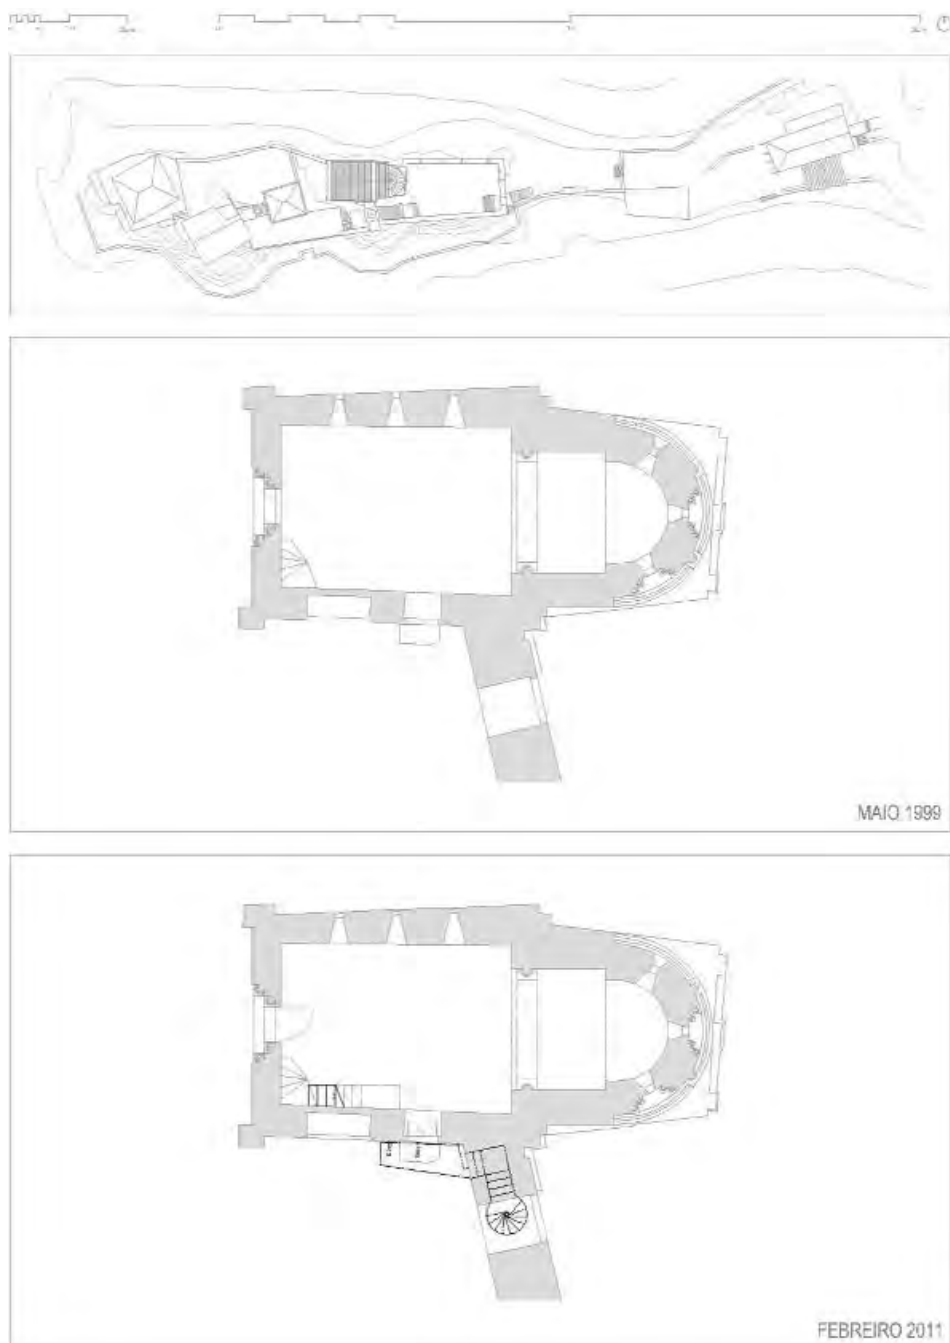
CAAVEIRO. Planta da Igreja de Santa Isabel.
